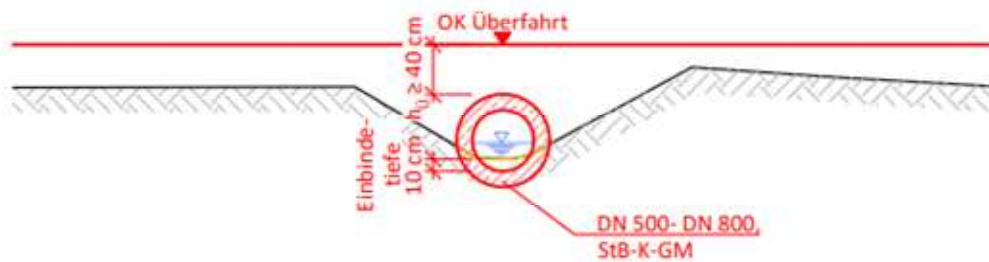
Querschnitt der Teilverrohrung (Stahlbeton Rohrdurchlässe für niedrige Überdeckung)
